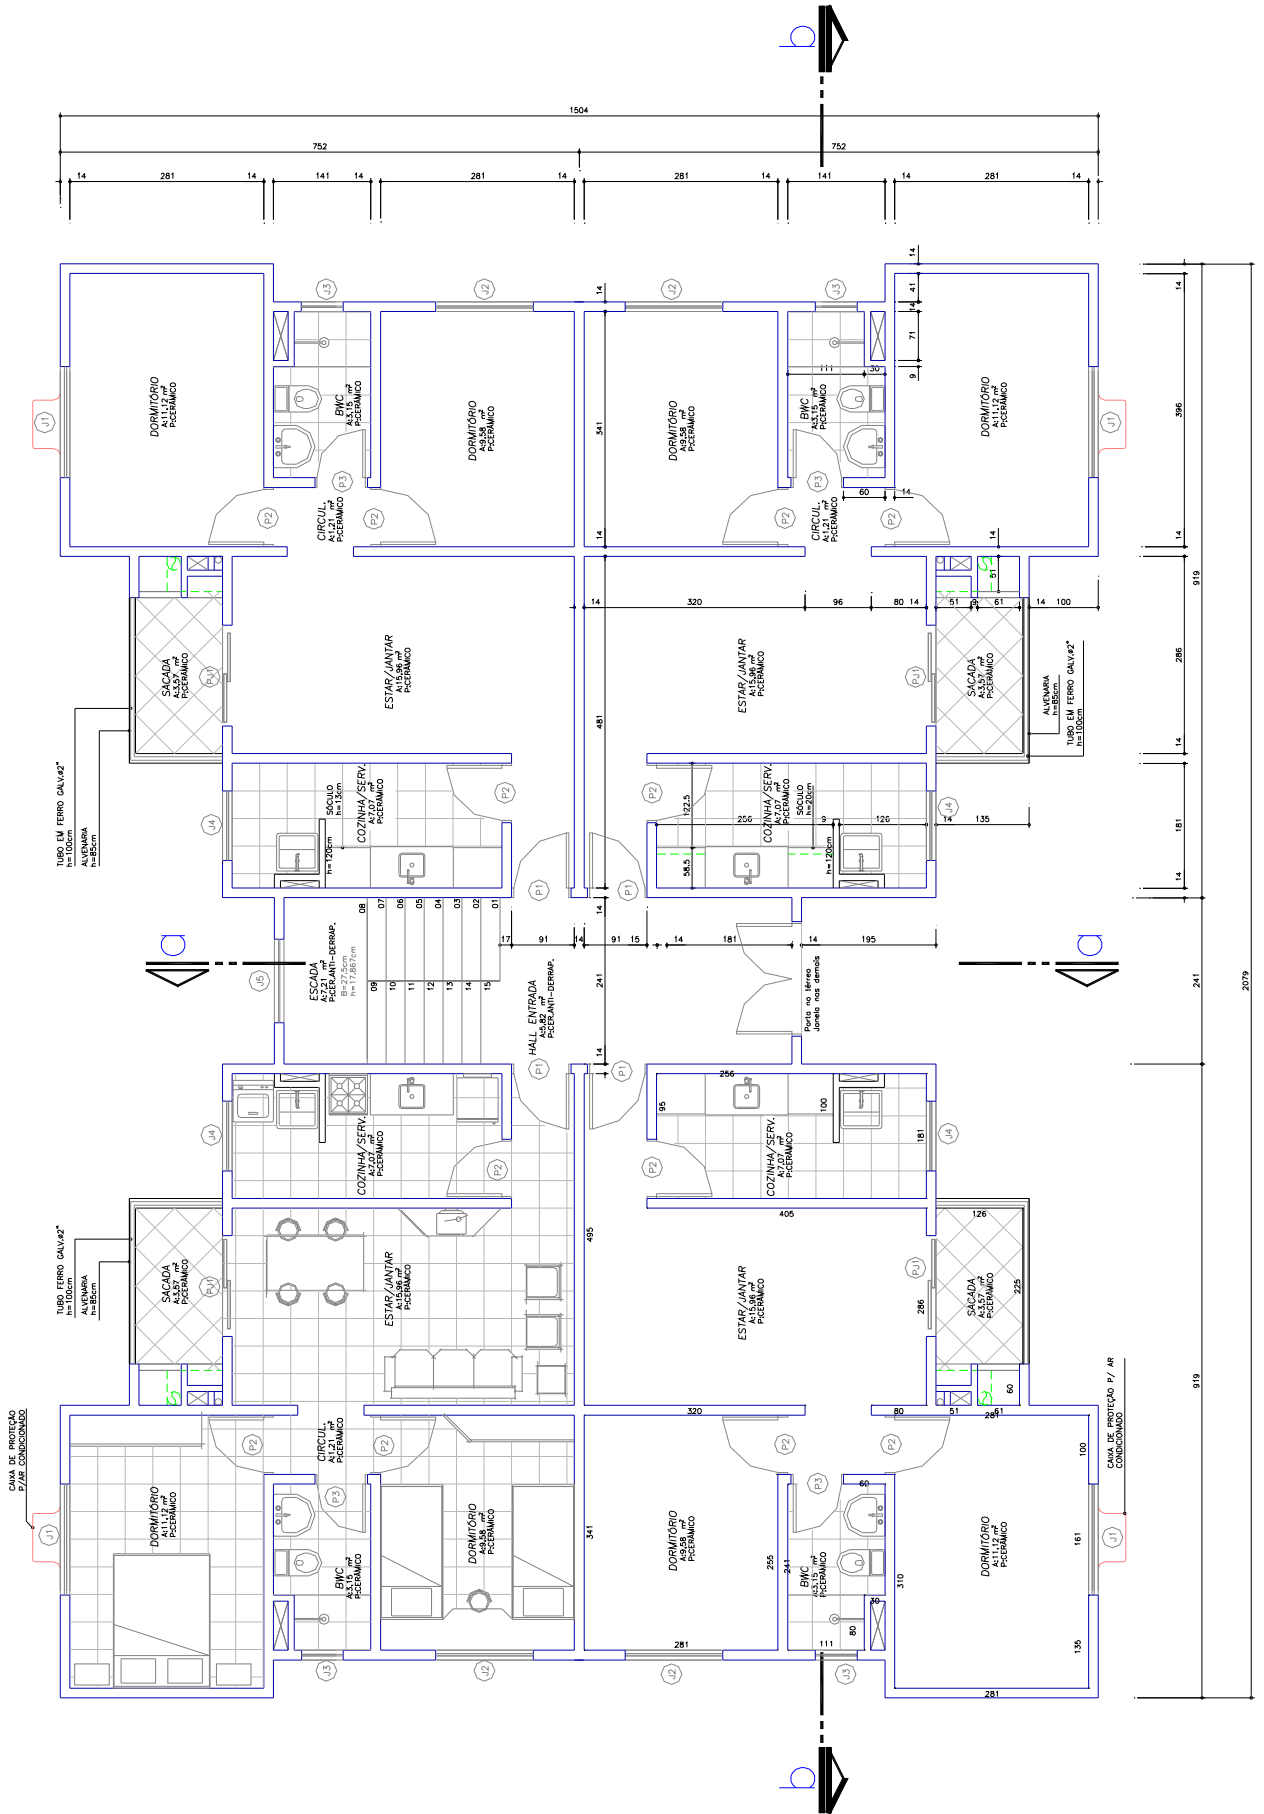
planta baixa do pavimento tipo do prédio modelo (s/esc)
